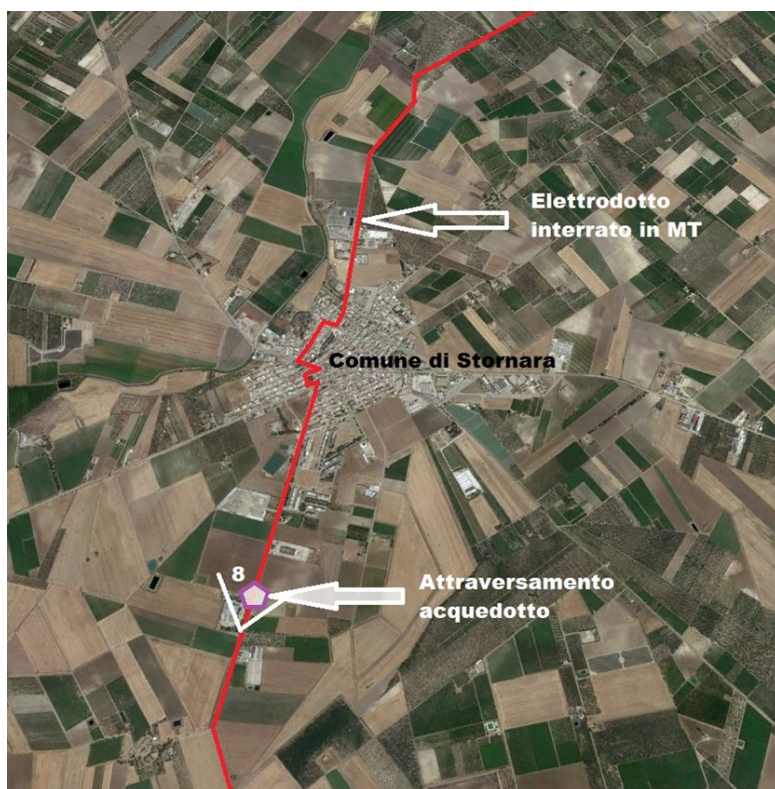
Planimetria di dettaglio n.3 con principali interferenze
